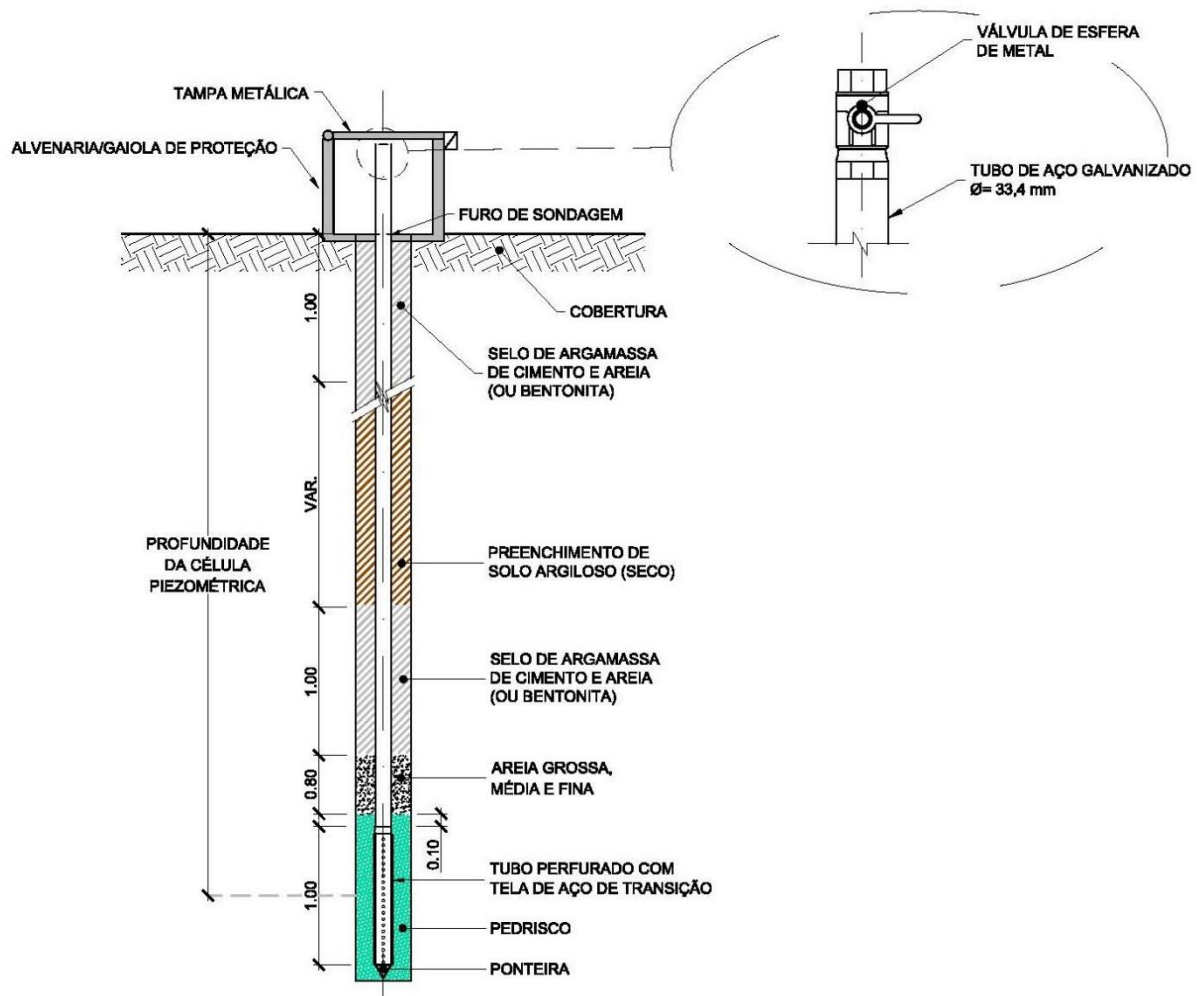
Perfil esquemático de Piezômetro tipo “stand pipe” ou Geotech.
